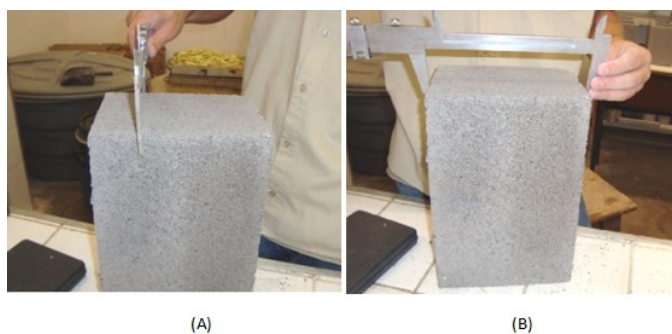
A) Análise dimensional largura. B) Análise dimensional altura
